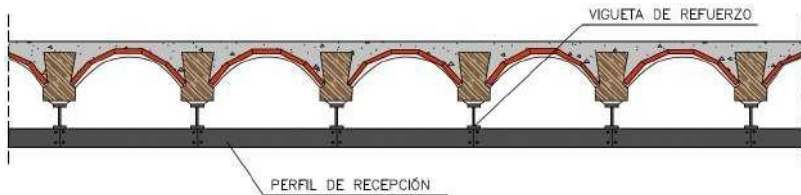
Perfil de refuerzo bajo vigueta existente. Fuente propia
